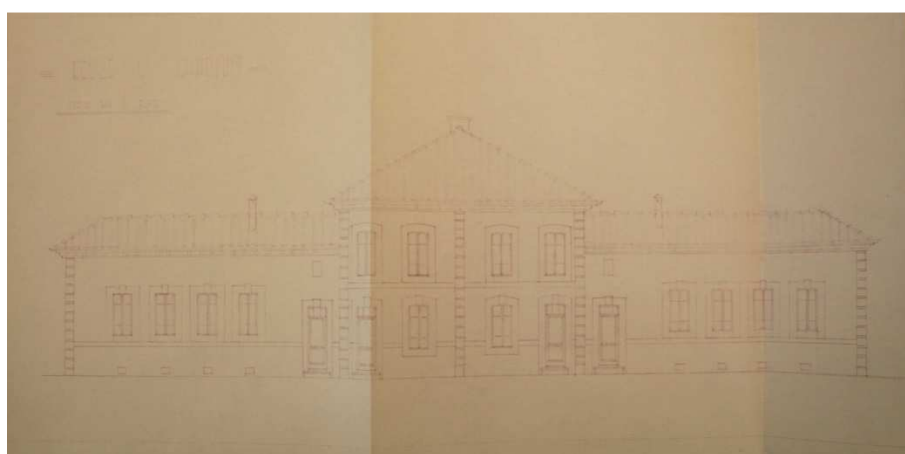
Projet de construction d'un groupe scolaire laïque, mobilier.
